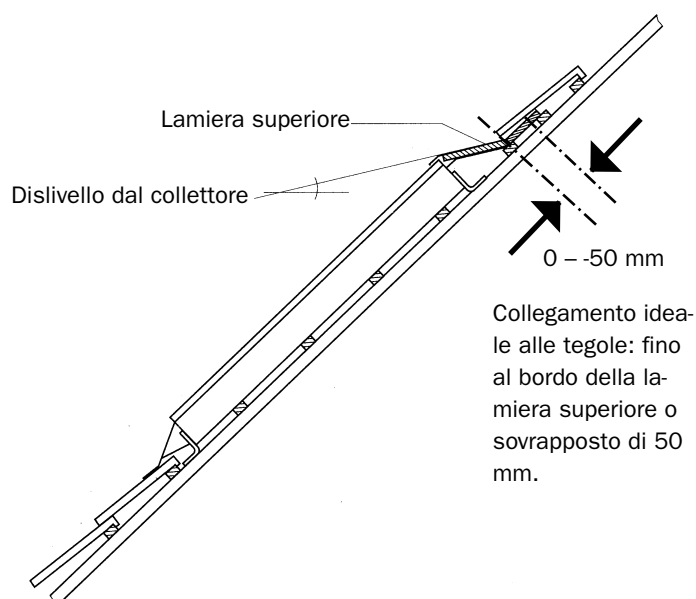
Vista in sezione del montaggio integrato nel tetto di SolvisFera
